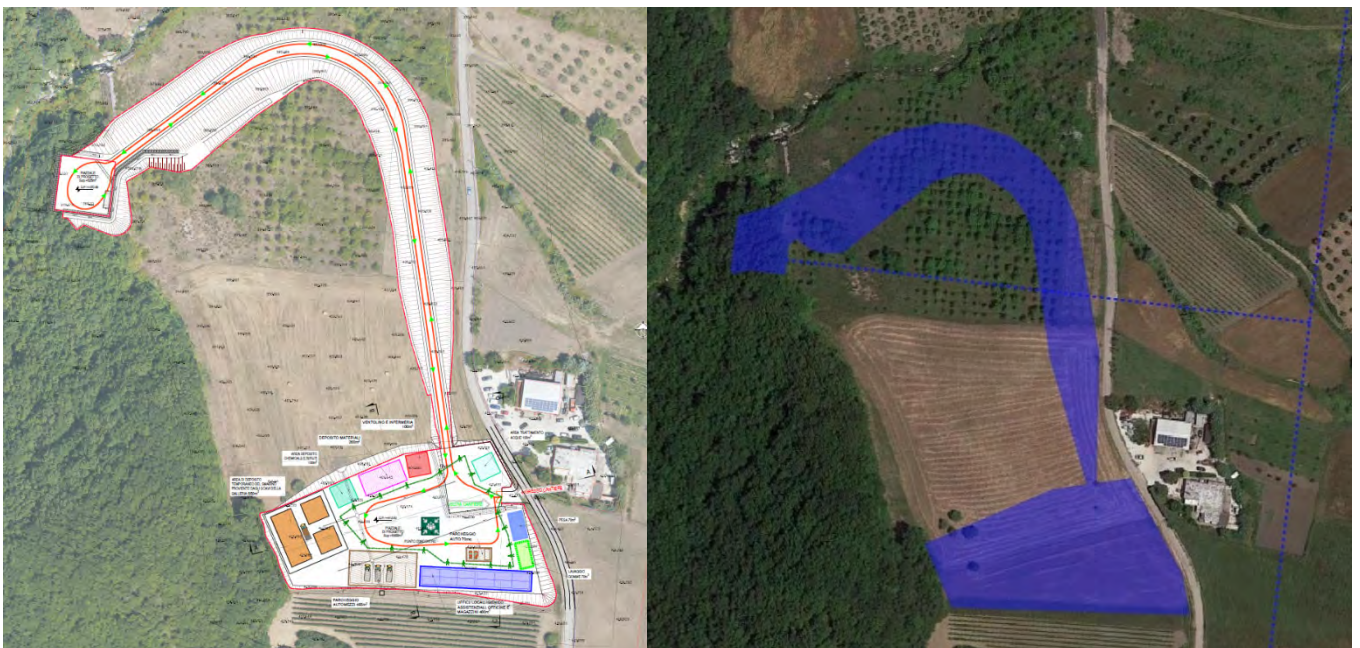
Layout cantiere scavo galleria discenderia laterale (COS2)
